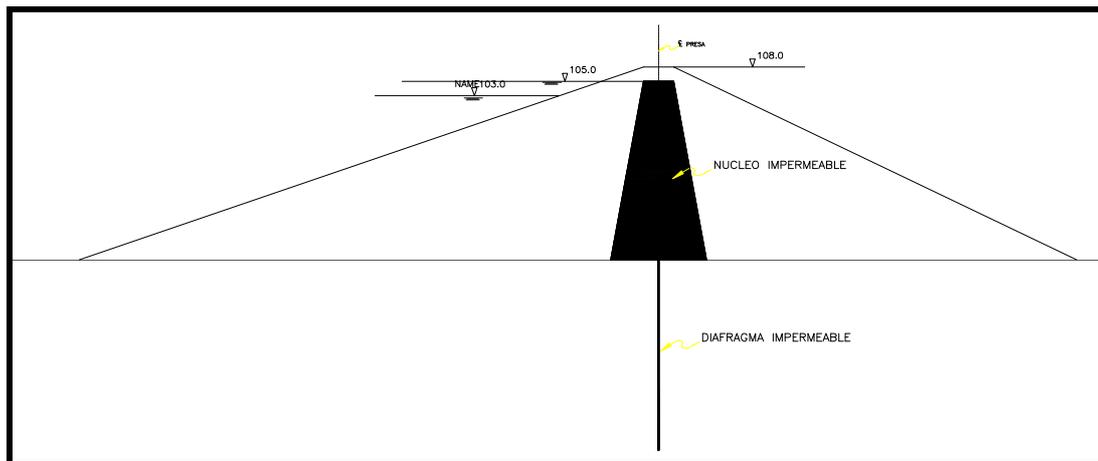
Se muestra un perfil aproximado de la sección transversal de presa Poechos
